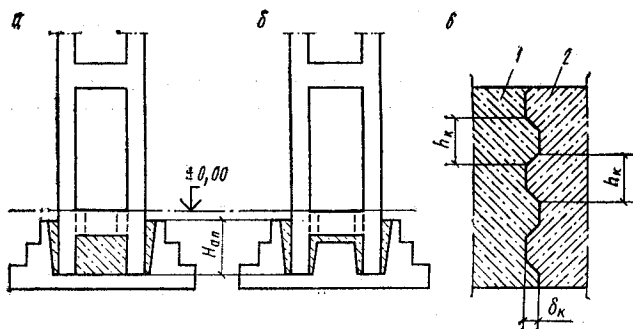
Конструкции соединения двухветвевой колонны с фундаментом
